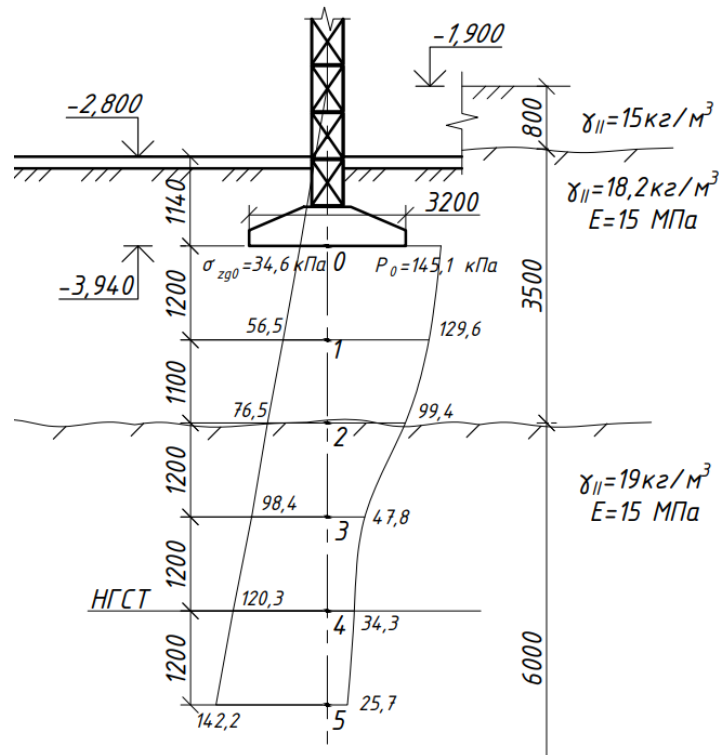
Расчетная схема осадки ленточного фундамента
